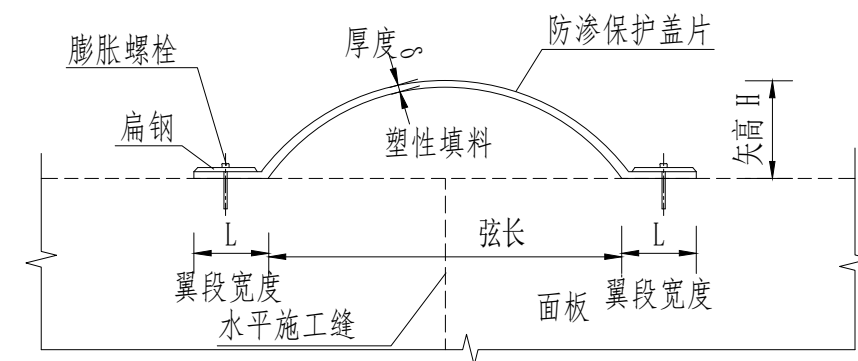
水平施工缝 (I型缝) 防渗保护盖片剖面图
